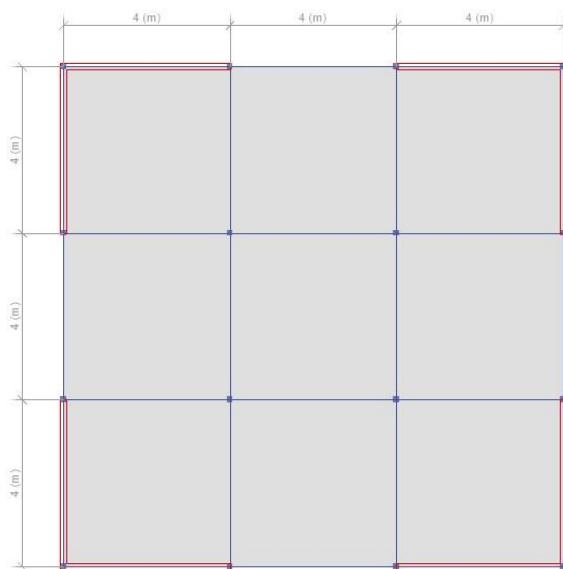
Vista en planta modelos G2.M1, G2.M2, G2.M3.
